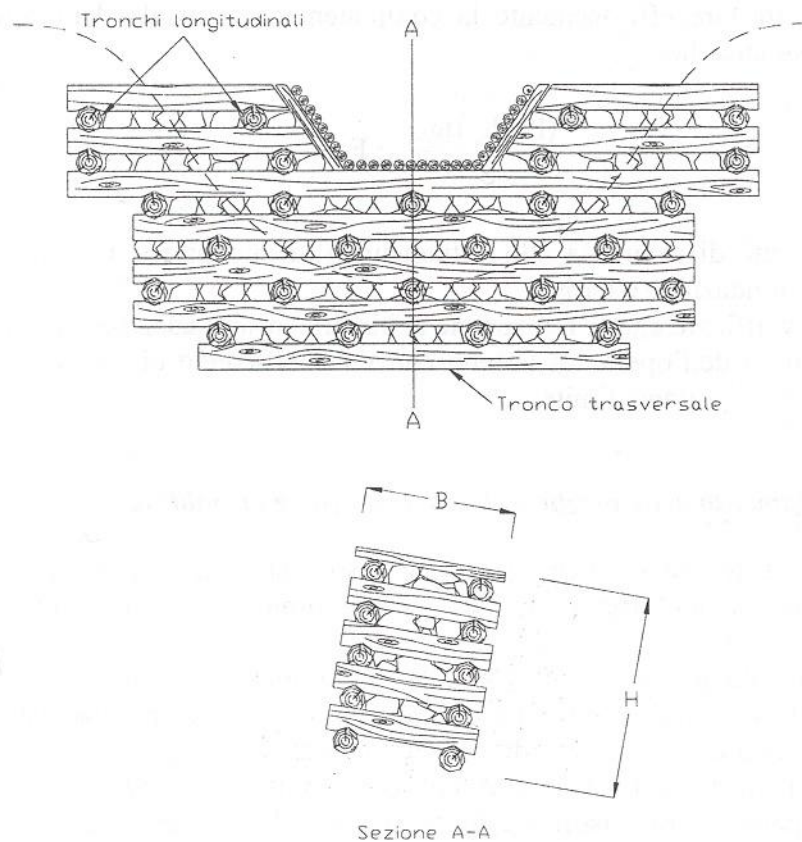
Prospetto e sezione di una briglia in legno e pietra.
